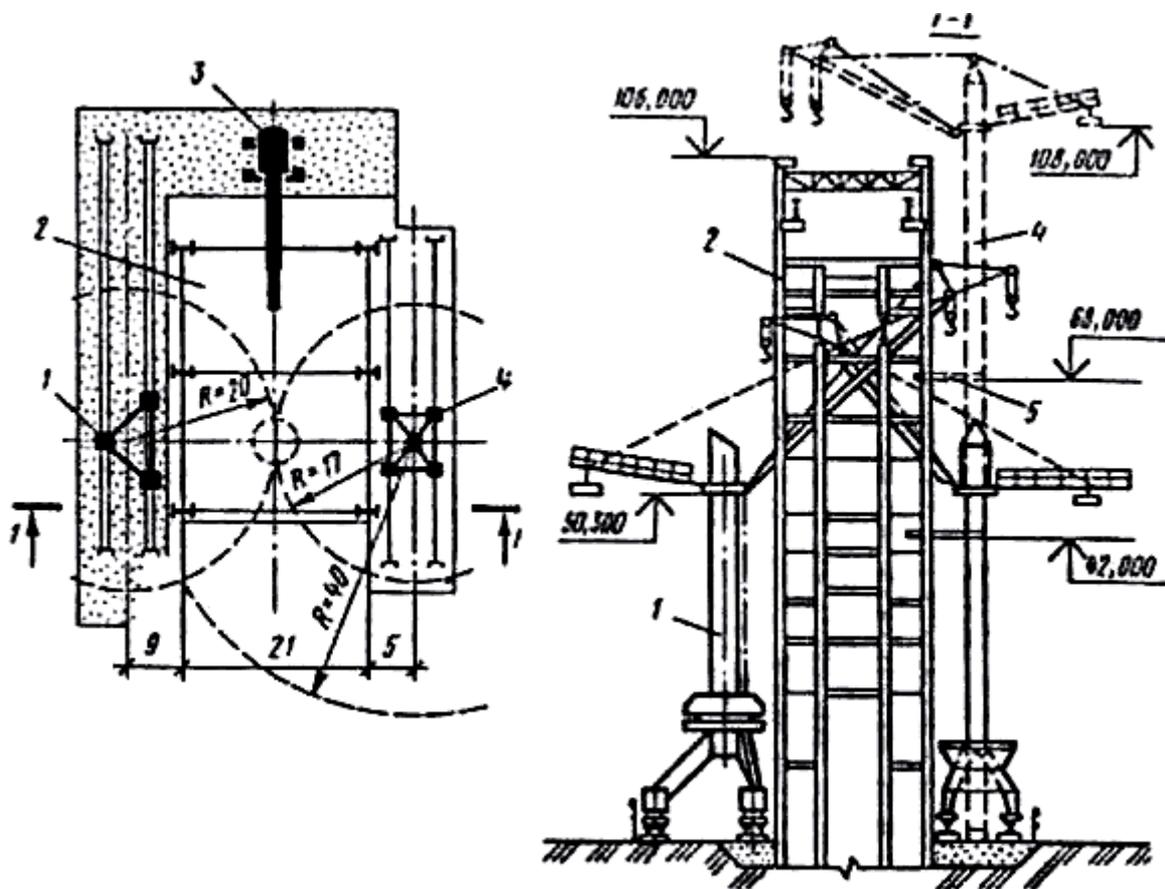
Схема механизации монтажа надшахтного здания (копра):
